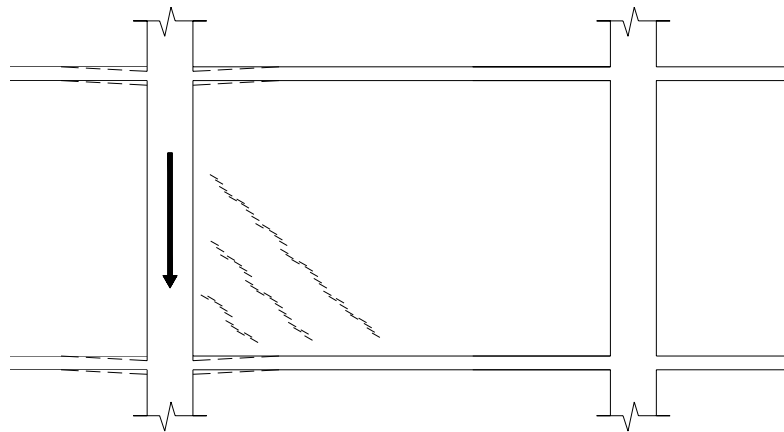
Fissuração em alvenarias devido a recalque. (Andrade, 2006).
